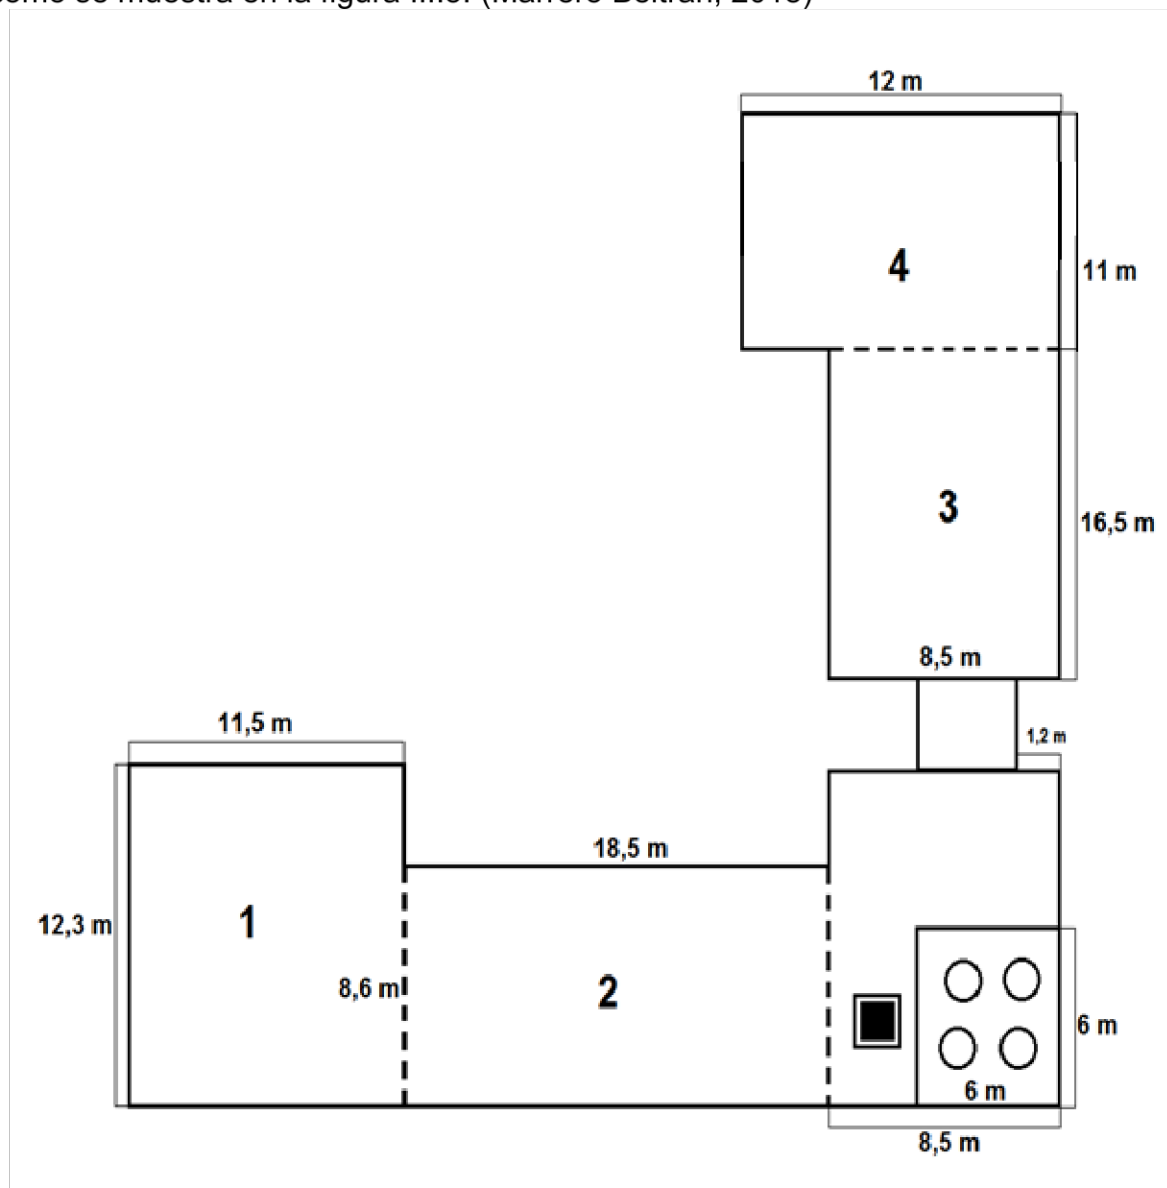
Áreas disponibles donde se instalarán los paneles. Fuente: Autores.
